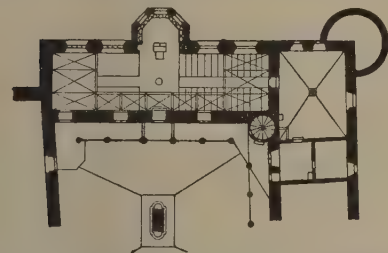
Schlosskapelle in Stuttgart. Erdgeschoß mit eingezeichneter Empore.
